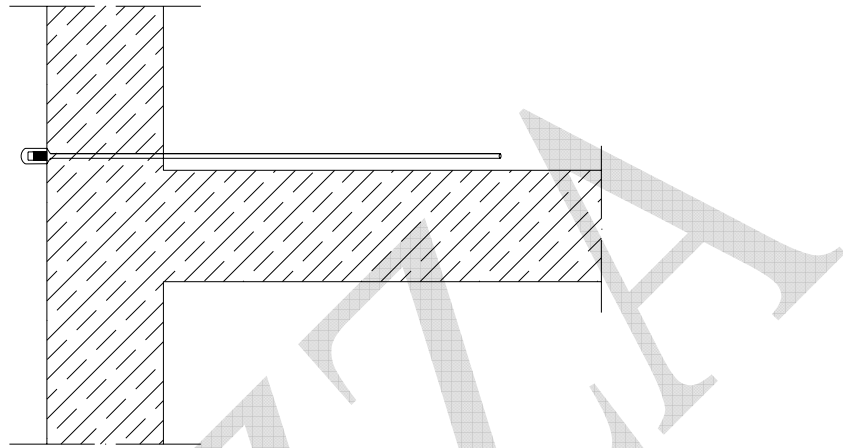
Vista in pianta di catena semplice aderente al muro trasversale a livello del solaio
